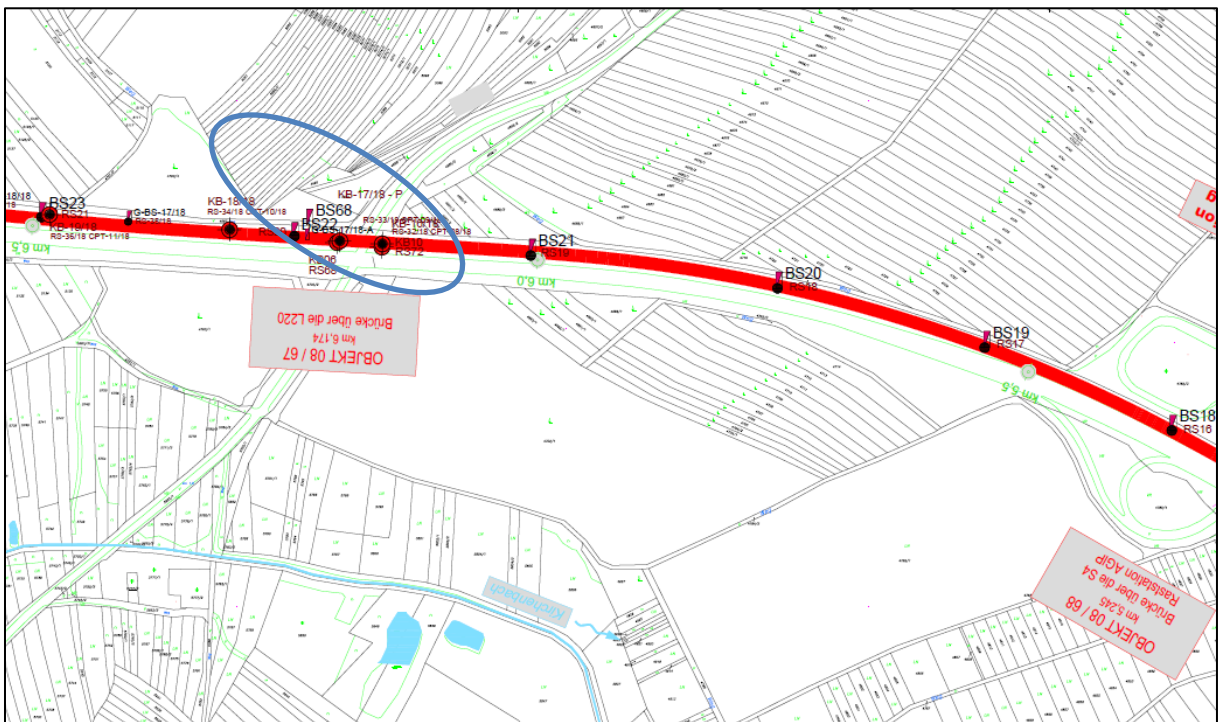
Kernbohrung 17 und 16 - Lageplan
